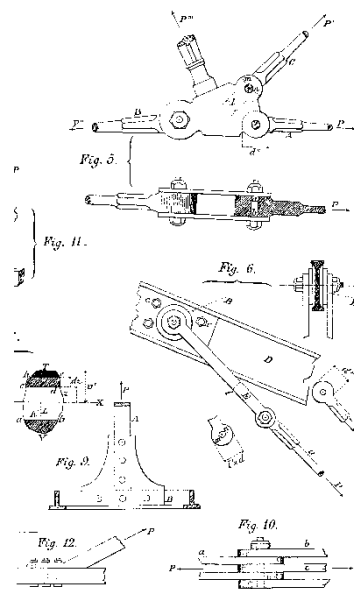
Detalles de unión de barras de cerchas metálicas, y otras uniones. Fuente: (Marvá Mayer, 1916).
